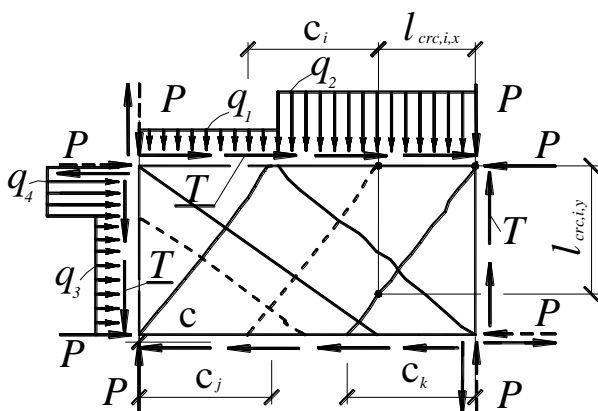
Пример базовых и смежных трещин плосконапряженных железобетонных конструкций при наложении геометрической и силовой концентрации:
